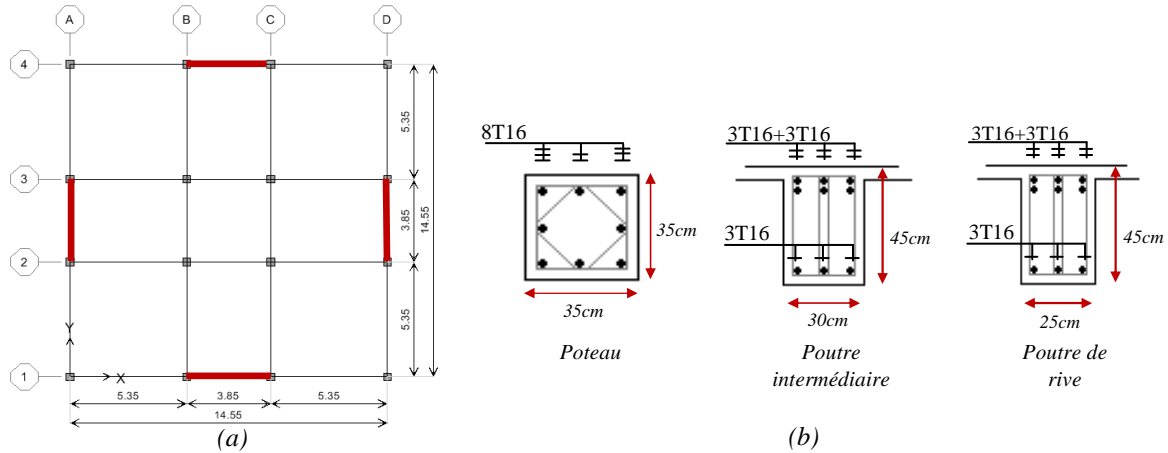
Structure analysée ; (a) vue en plan (b) ferrailage des poteaux et poutres
